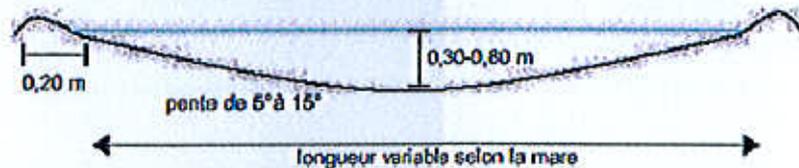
Profil d'une mare à Craud Calamite (source : LPO Isère, Plan de conservation du Craud Calamite)
